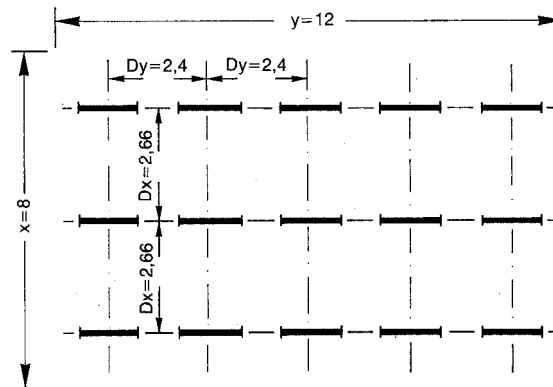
Disposizione degli apparecchi illuminanti.
